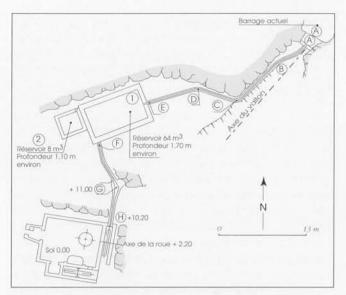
EZE, moulin oublié. Plan des installations (A. Tiret).
